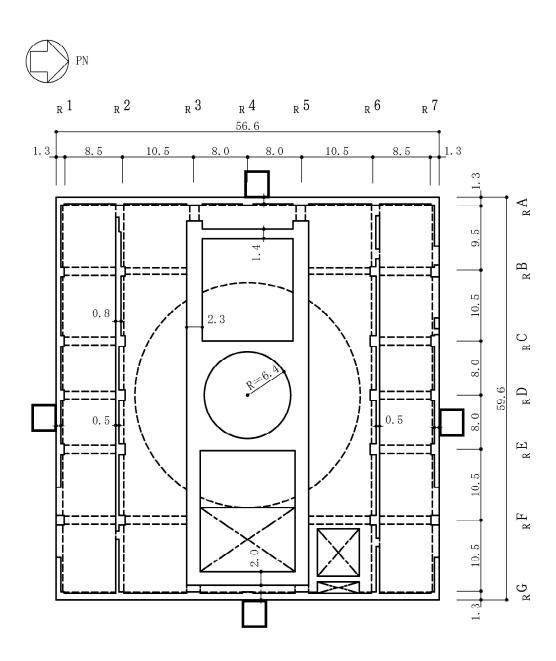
原子炉建屋の概略平面図 (3F, T.M.S.L.23.5m) (6/9) (単位:m)
